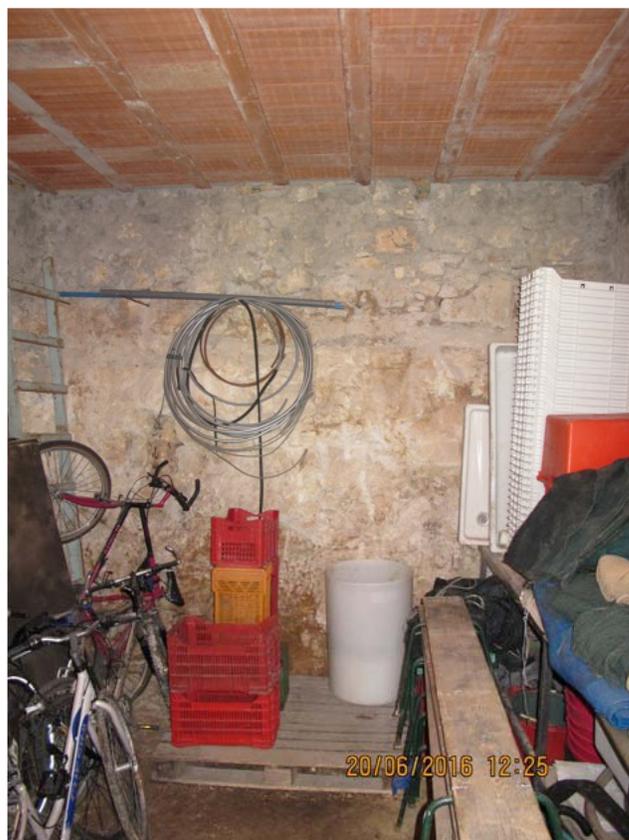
Appartamento con solaio portante in laterocemento e parte rivestimento con travi e assitto
